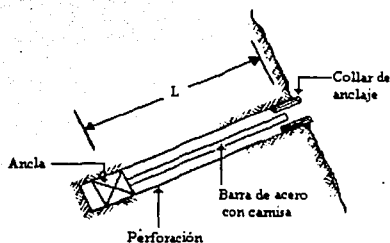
Principio de operación de un extensómetro fijado en una perforación.
